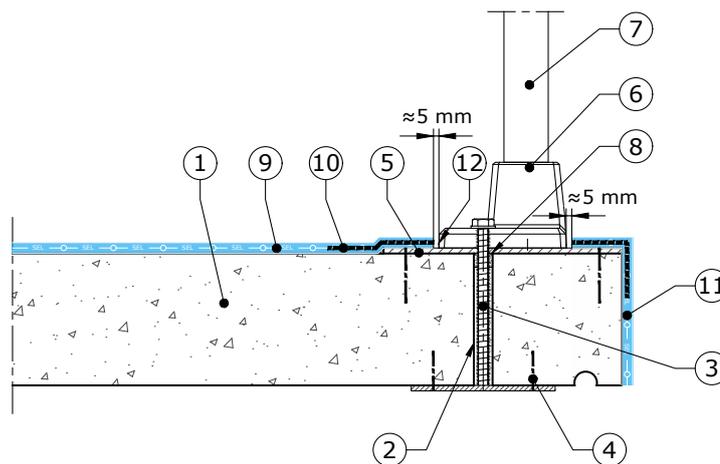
Travaux de rénovation - Garde-corps avec fixations traversantes - Exemple
